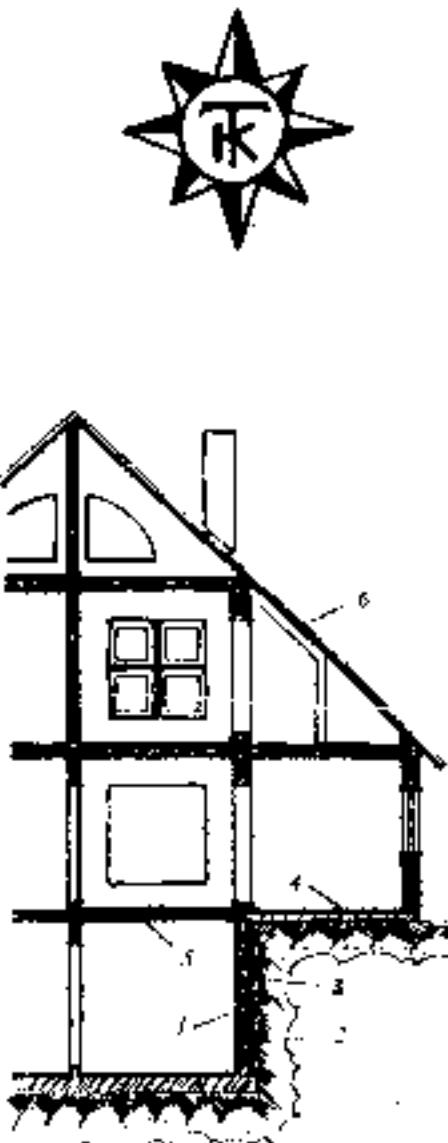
Фрагмент разреза коттеджа с подвалом и мансардным этажем
